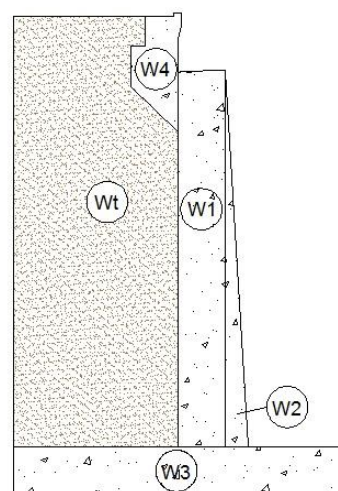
Figura XI: SECCIÓN PROPUESTA PARA EL ESTRIBO
